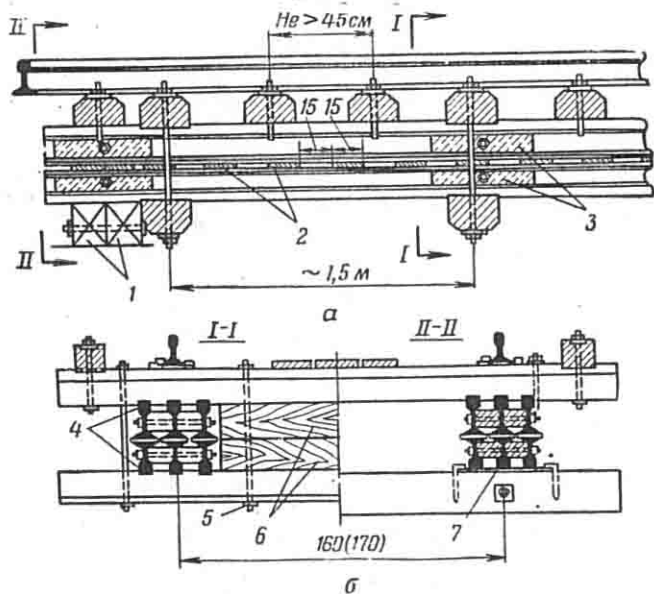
Пролетное строение из двухпоручных рельсовых пакетов: а — фасад: 1 — опорные брусья $16 \times 20 \times 250$ см; 2 — шпонки 150×12 мм; 3 — деревянные прокладки длиной 30 см; б — вид по I-I и II-II: 4 — врубка 1—2 см; 5 — болт диаметром 19 мм; 6 — деревянная распорка; 7 — опорный лист
